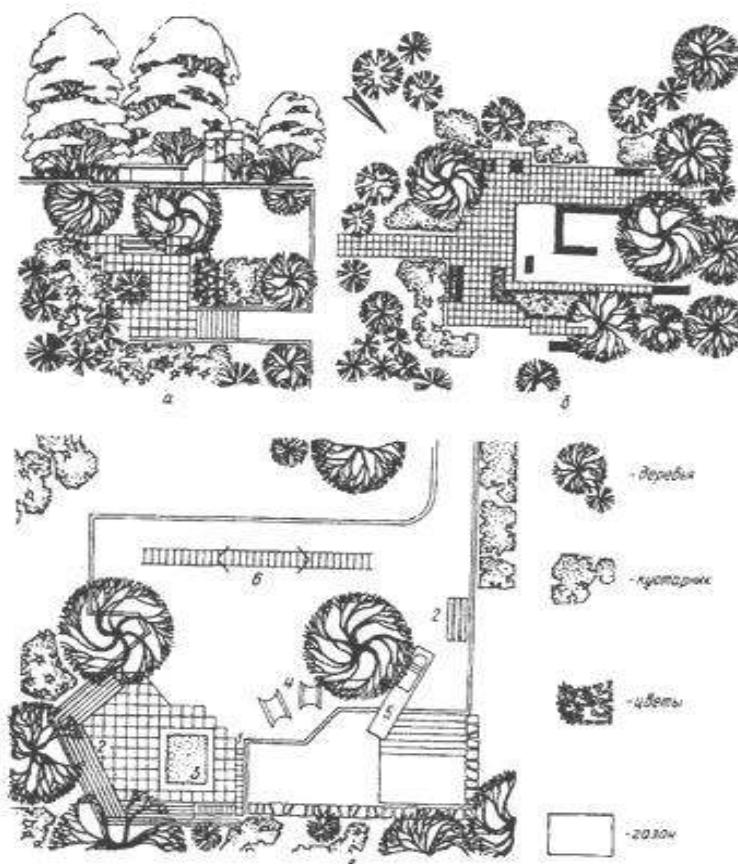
Примеры планировки площадок (Теодоронский В.С., 2003): а - площадка для тихого отдыха; б - площадка для детей 6 лет; в - комплексная площадка: 1 - пергола; 2 - скамья; 3 - песочница; 4 - качалка; 5 - горка; 6 - лиана для лазания
